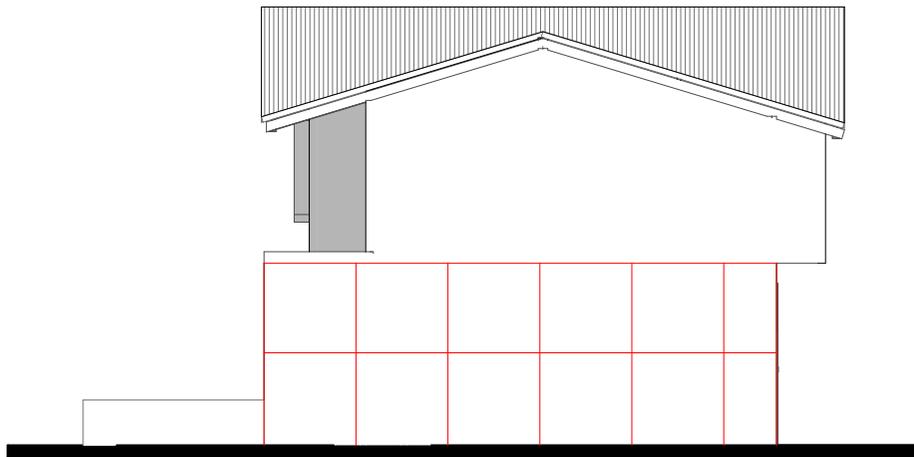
Modulaci3n de paneles en fachada lateral derecha.
